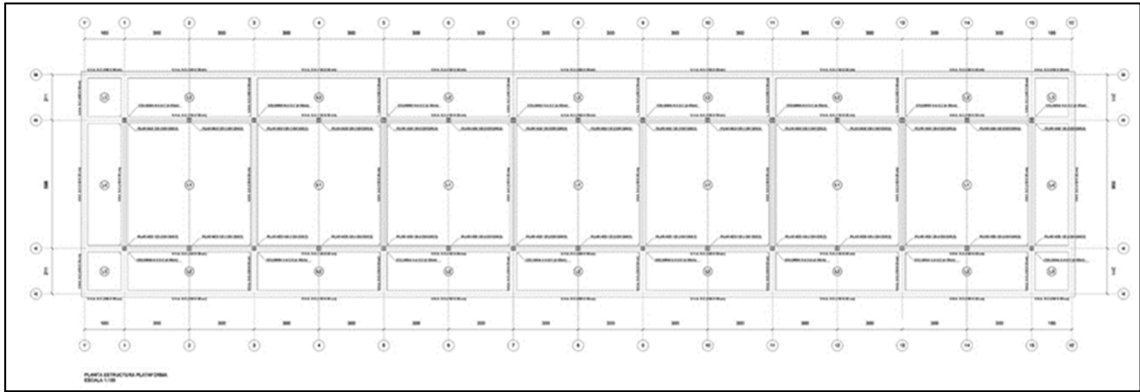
PLANTA ESTRUCTURA DE PLATAFORMA
